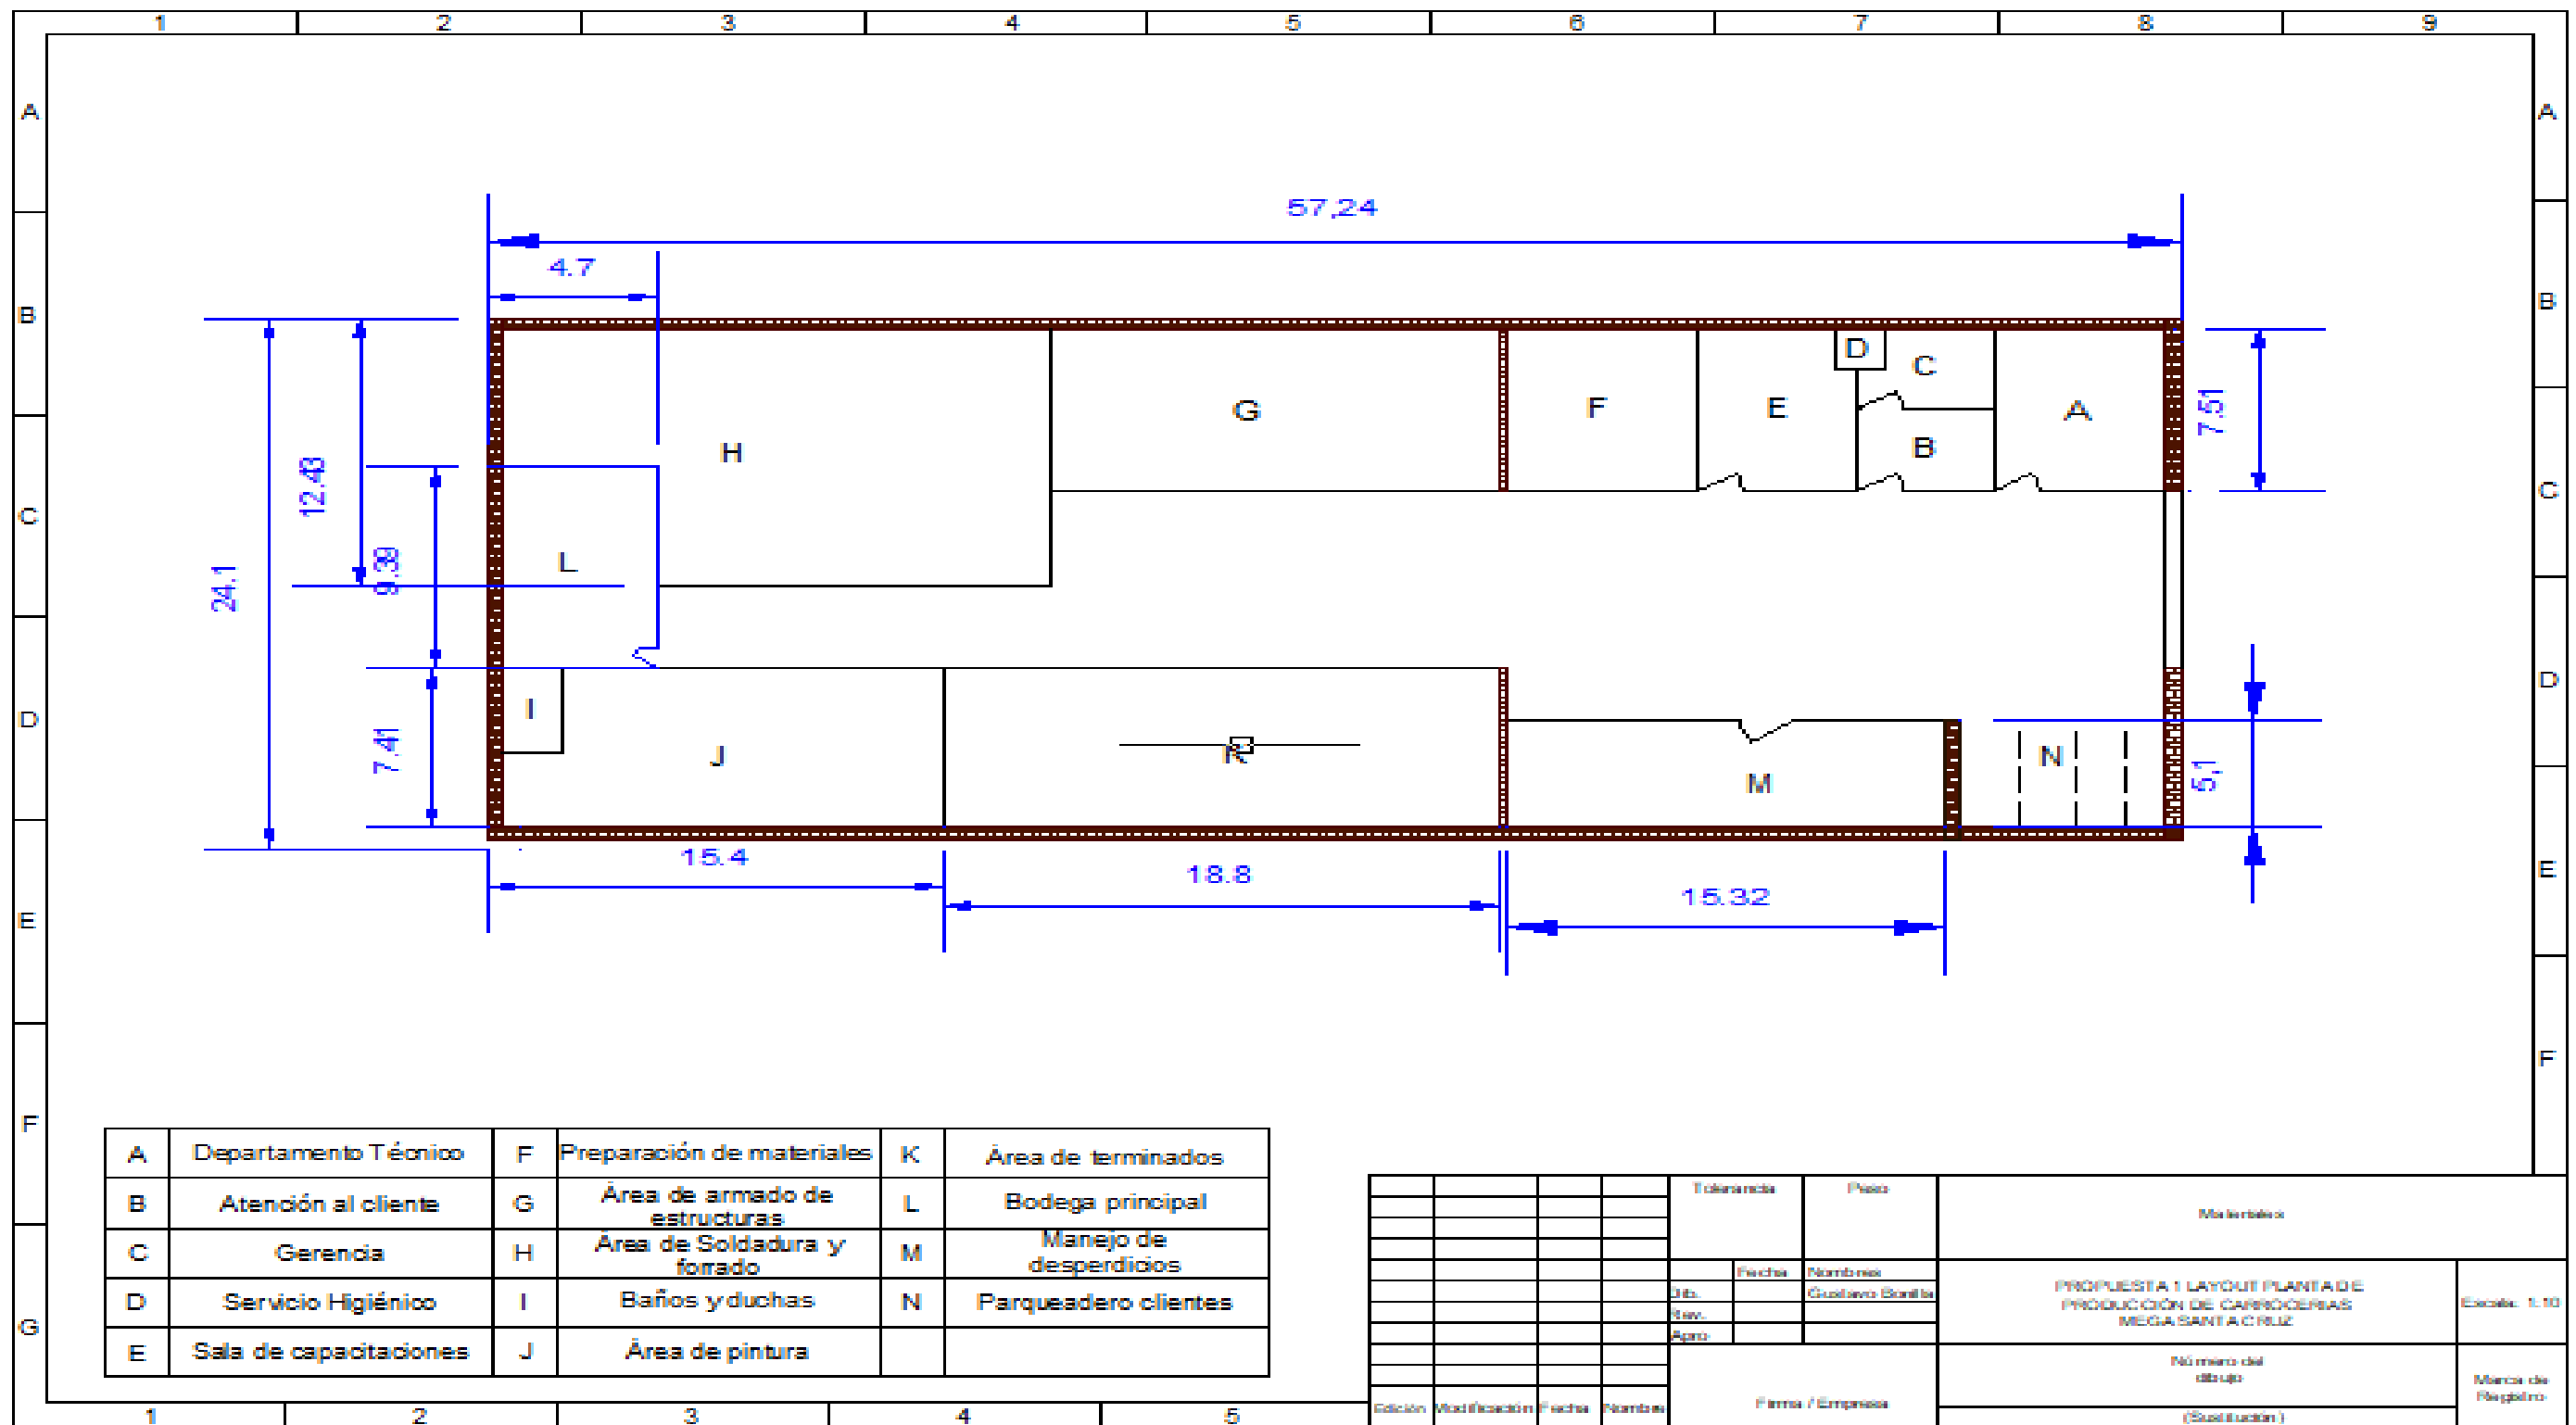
Áreas de la planta de Carrocerías Mega Santa Cruz (Propuesta 1)
